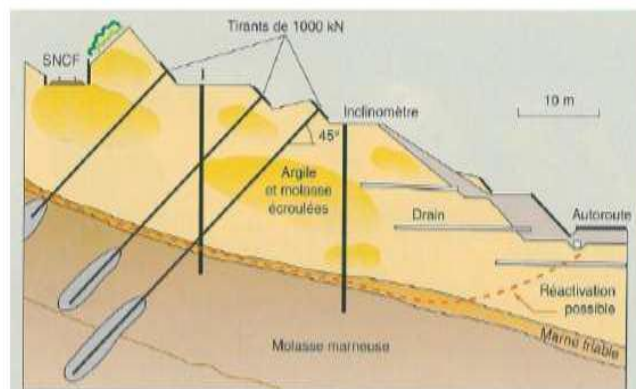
Renforcement par tirant sur l'autoroute A 41, (Haute-Savoie).
